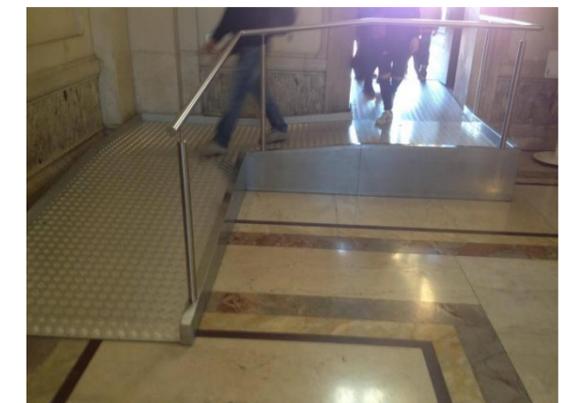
Rampe d'accès terrasse Palazzo (Rome)
